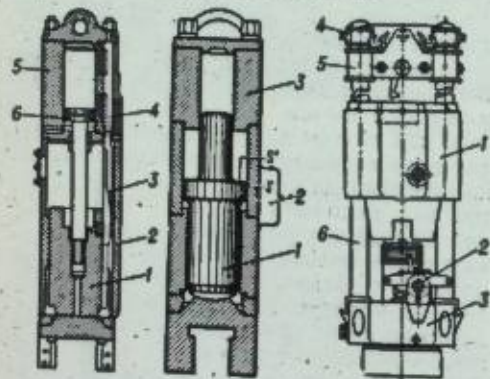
Паровоздушный молот двойного действия с простым поршнем: 1 — ударная часть (бок); 2 — корпус бойка; 3 — шток с винтовой нарезкой для привода золотника; 4 — золотник; 5 — рабочий цилиндр; 6 — поршень со штоком.
